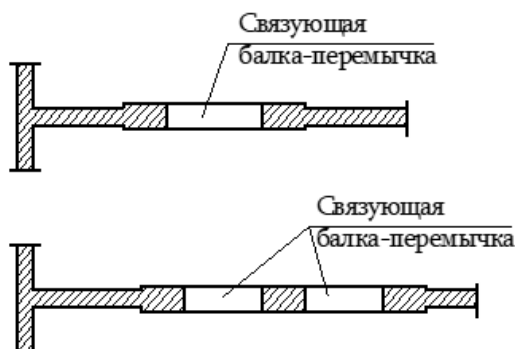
Примеры увеличения толщин перемычек без общего увеличения толщины стен
